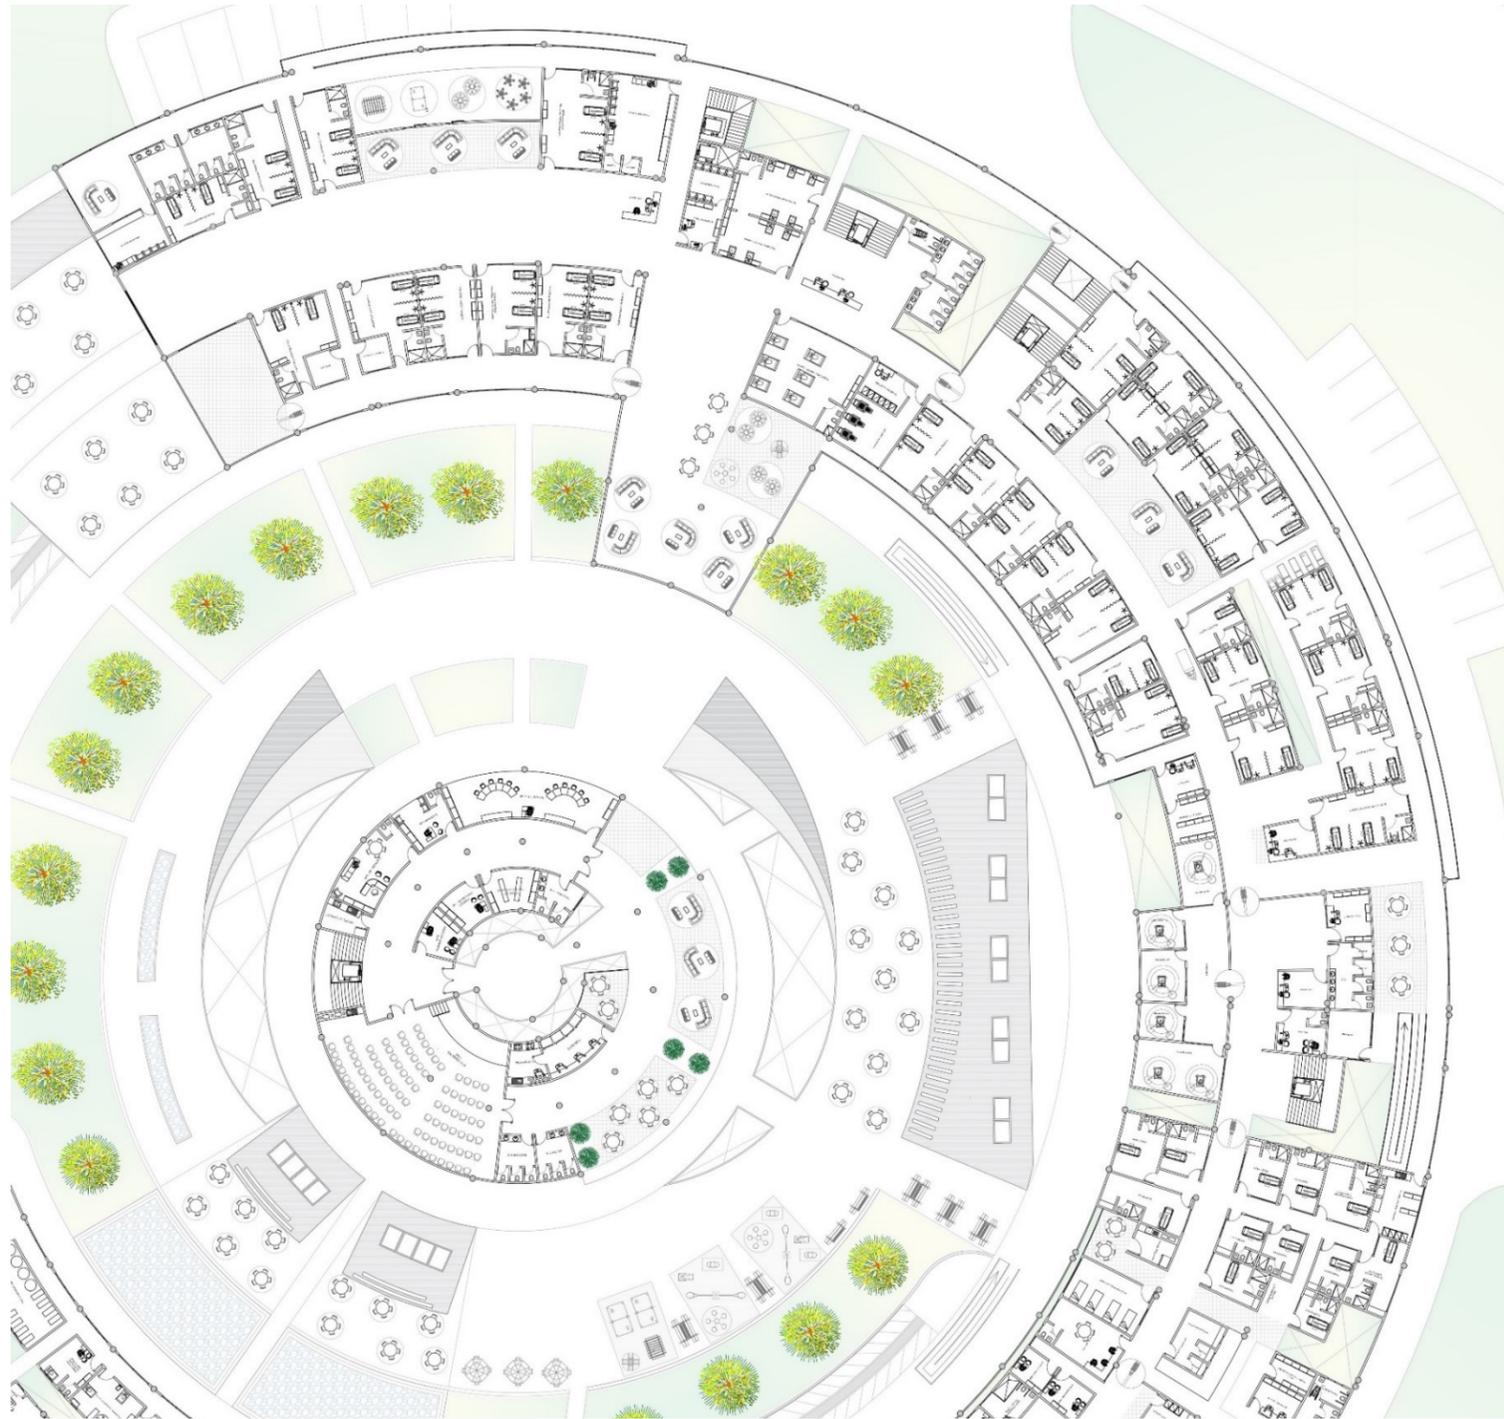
Planta arquitectónica unidad Hospitalización. / Fuente: Elaboración propia.
